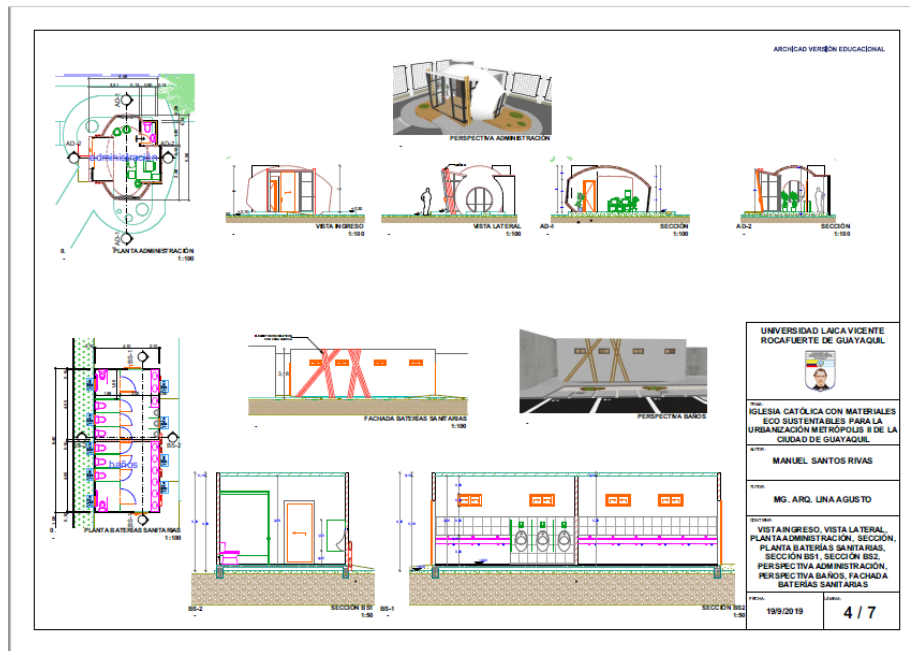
Lámina con detalles de baterías sanitarias y administración.
